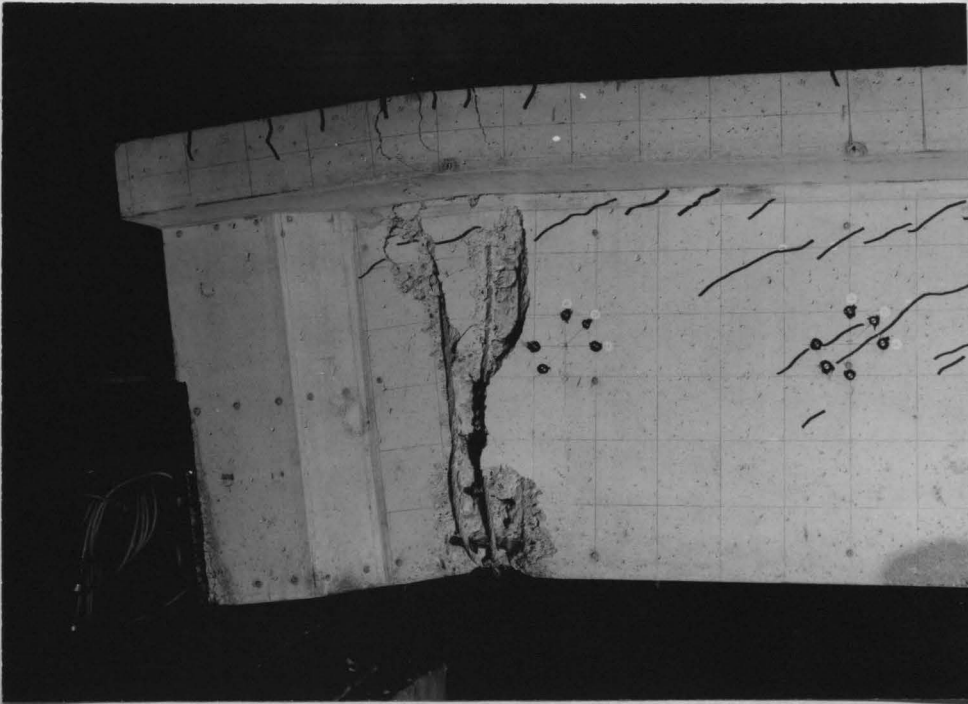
Bruchbereich des Versuchsbalkens B3
